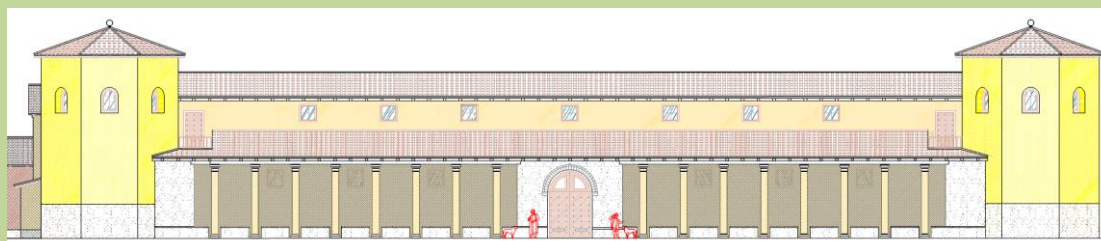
Alzado del ala sur de La Olmeda (reconstrucción virtual -I-). CGS.
